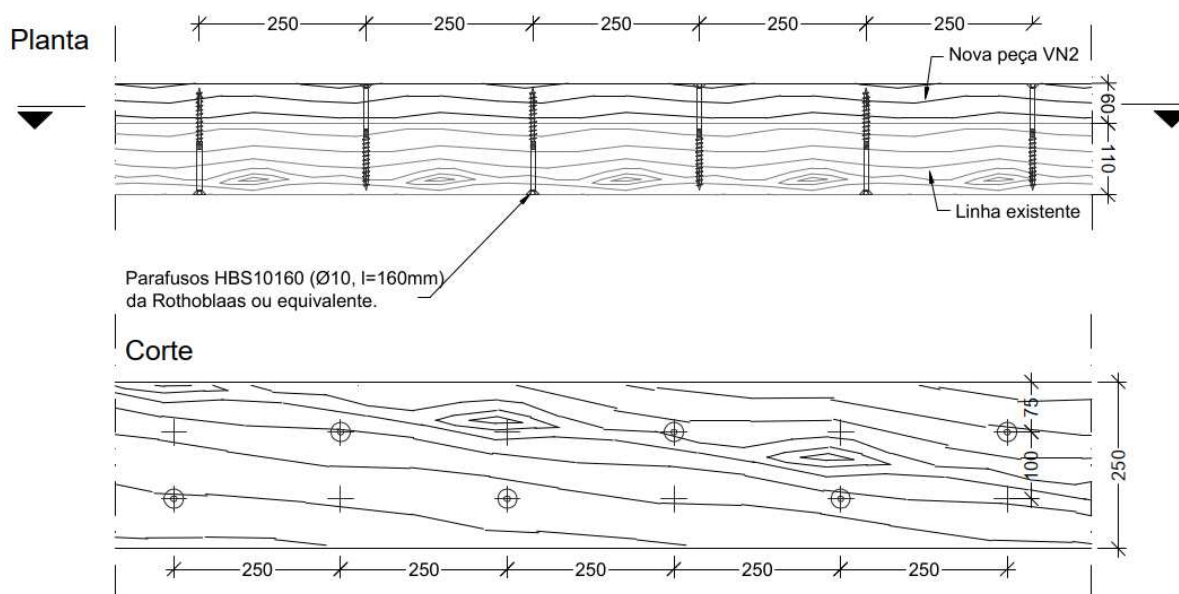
Pormenor de ligação entre a linha da asna existente e uma peça de madeira nova
